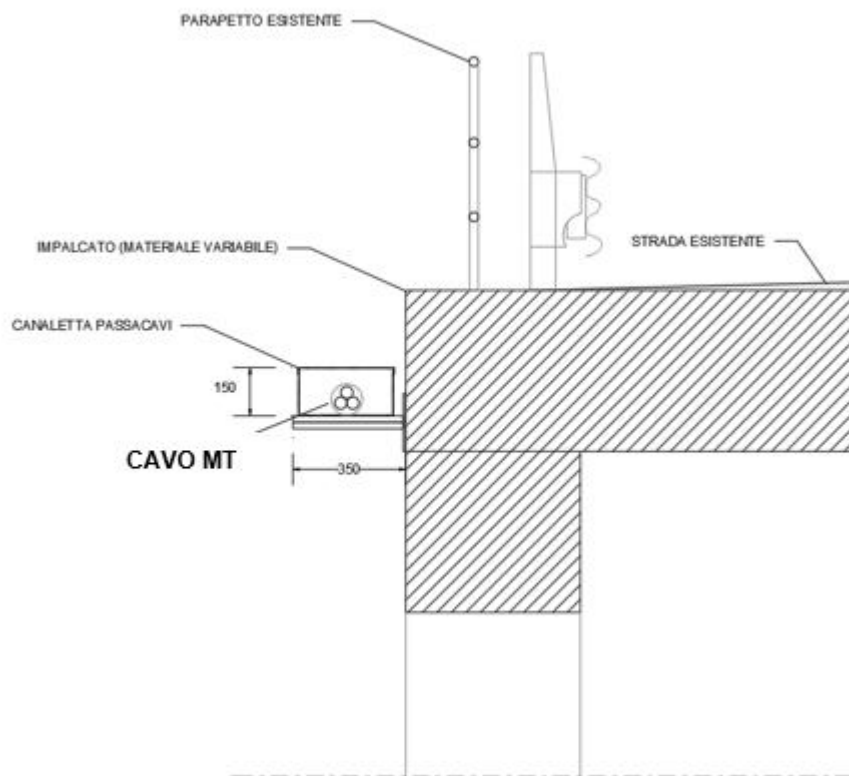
Tipologico della sezione del cavidotto in canaletta in fiancheggiamento dell'attraversamento carrabile per cavo MT.
